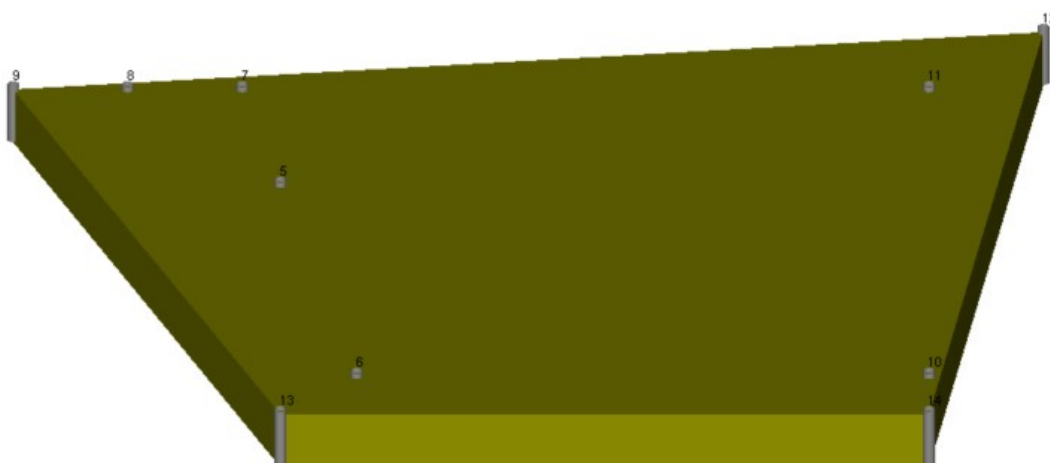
3D модель грунтового основания под фундаментом
